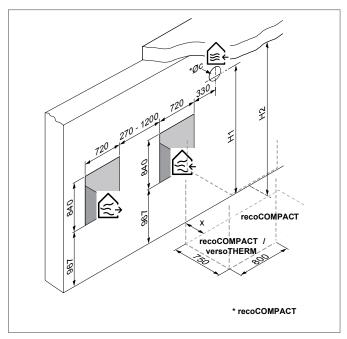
Installazione parallelamente alla parete, ingresso aria a destra
